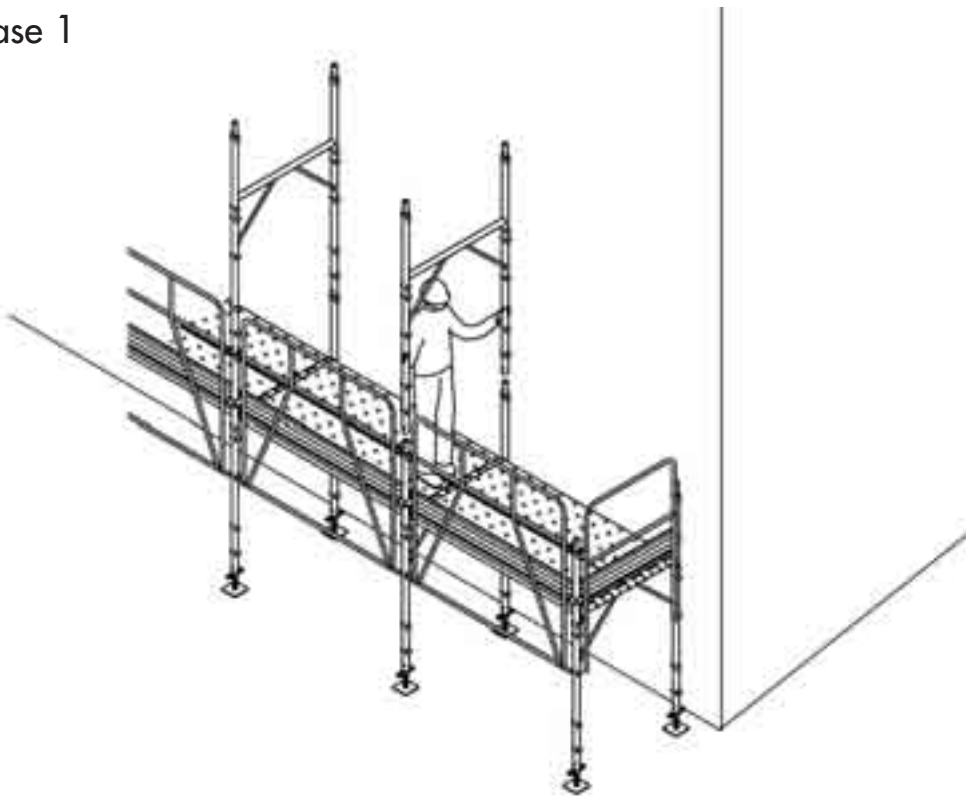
Esempio di ponteggi a telai con parapetto di protezione collettiva
